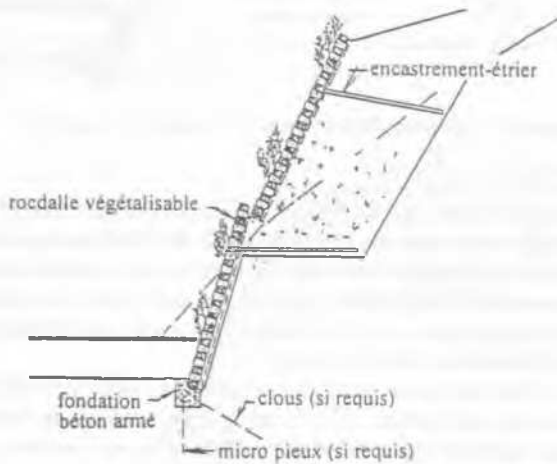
Soutènement avec rocdalles végétalisables - Coupe type
